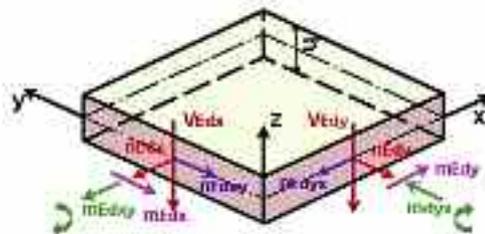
sollicitations pouvant agir sur un élément de dalle
